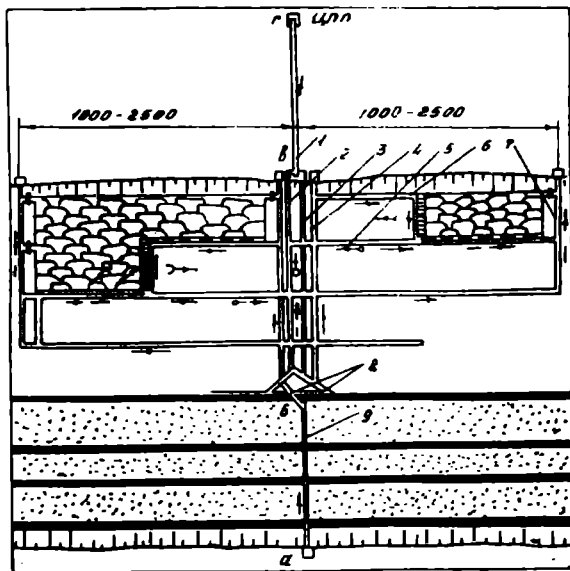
Схема подготовки и отработки угольного пласта при вскрытии поля наклонными выработками (разрез по абвг на рис. 4.1 б)
